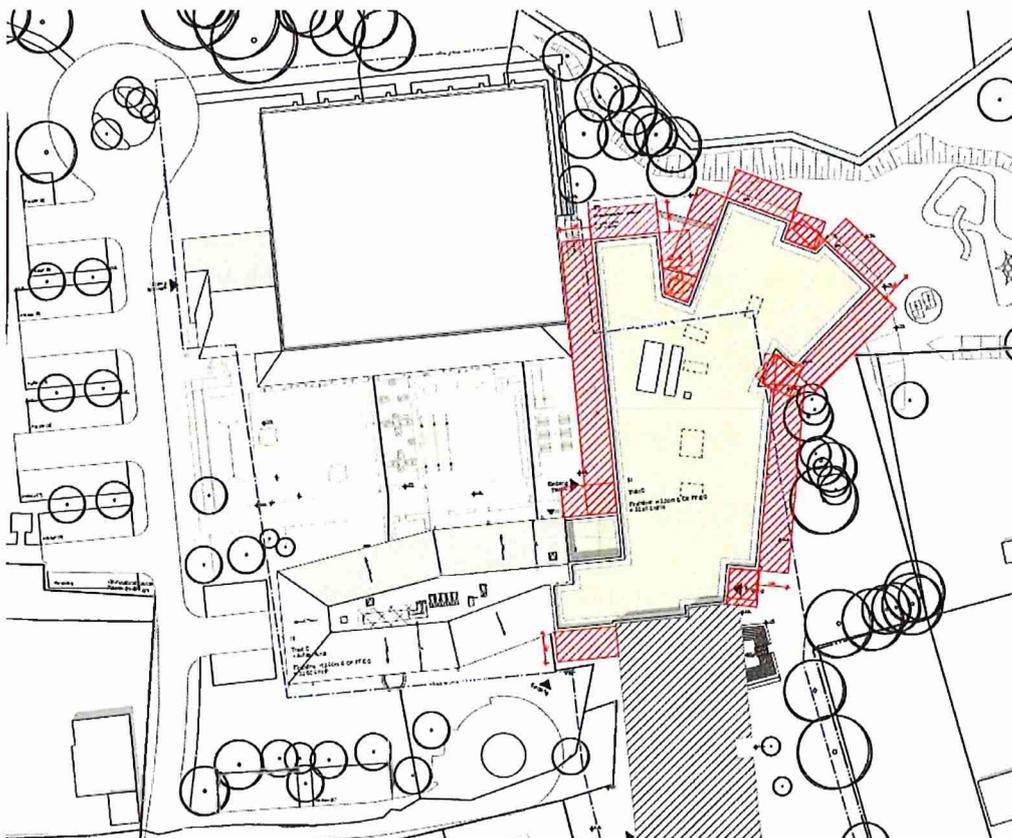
Erweiterung Grund- und Gemeinschaftsschule Pönitz, Lageplan Trakt D, Trapez Architektur GmbH, 22.04.2021
